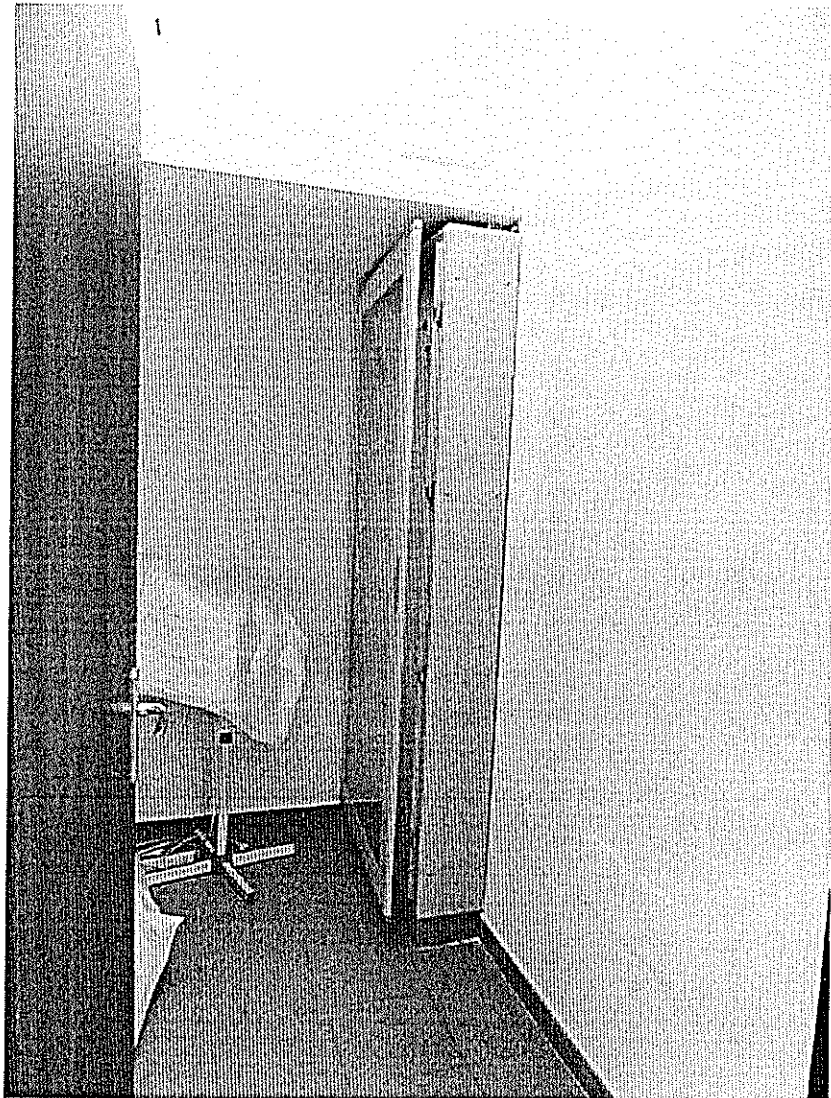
Locale quadri nell'ala nord del primo corpo di fabbrica – piano primo.
